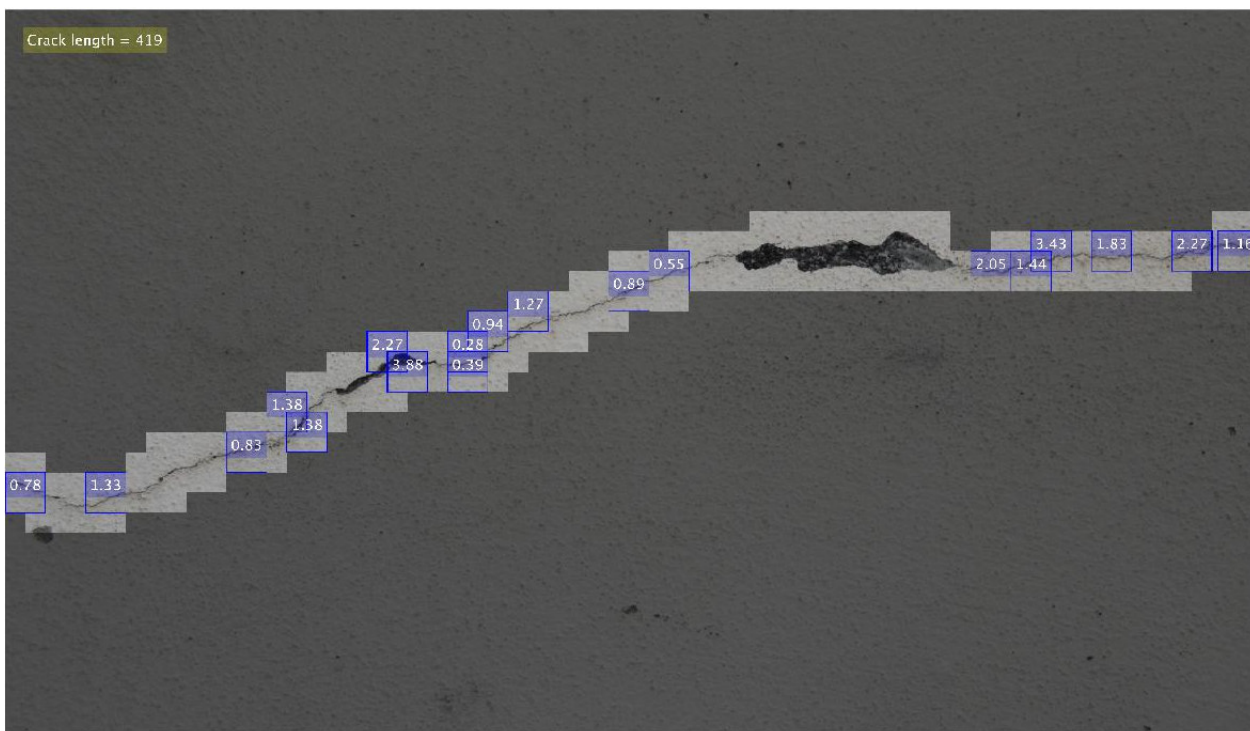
Detecção e caracterização da Fissura 4
